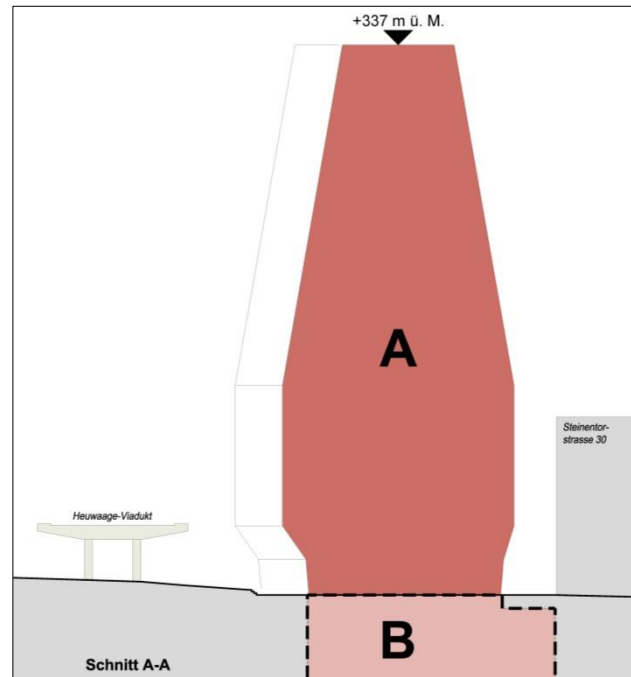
Bebauungsplan, Schnitt. (Kein Massstab, Plan genordet)
